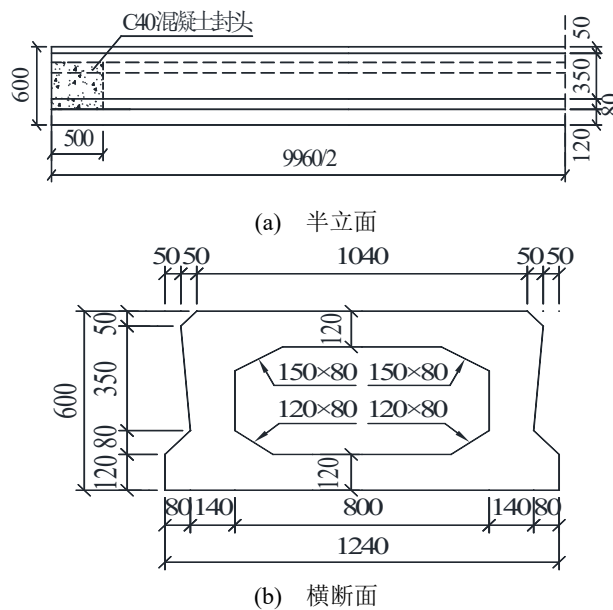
10 m 空心板梁半立面和横断面(单位:mm)
